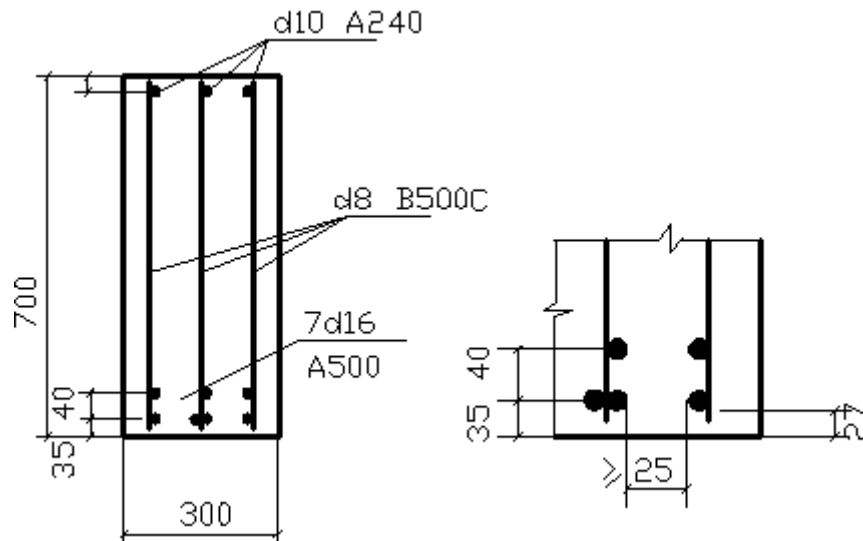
Размещение подобранной арматуры в ригеле
